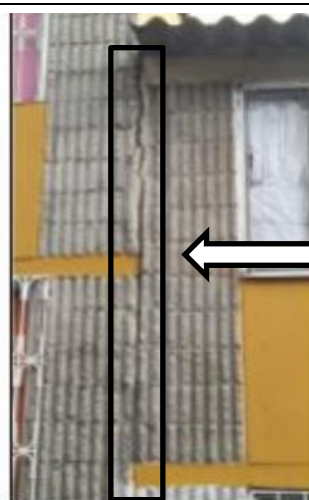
CALLE 41 A SUR No 16 A – 14 ESTE (DETERIORO FACHADA)
